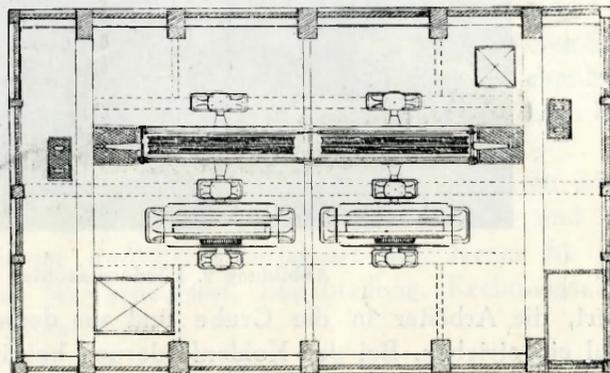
Grundriss der Köpffördermaschinen des Szent-István-Schachtes.
